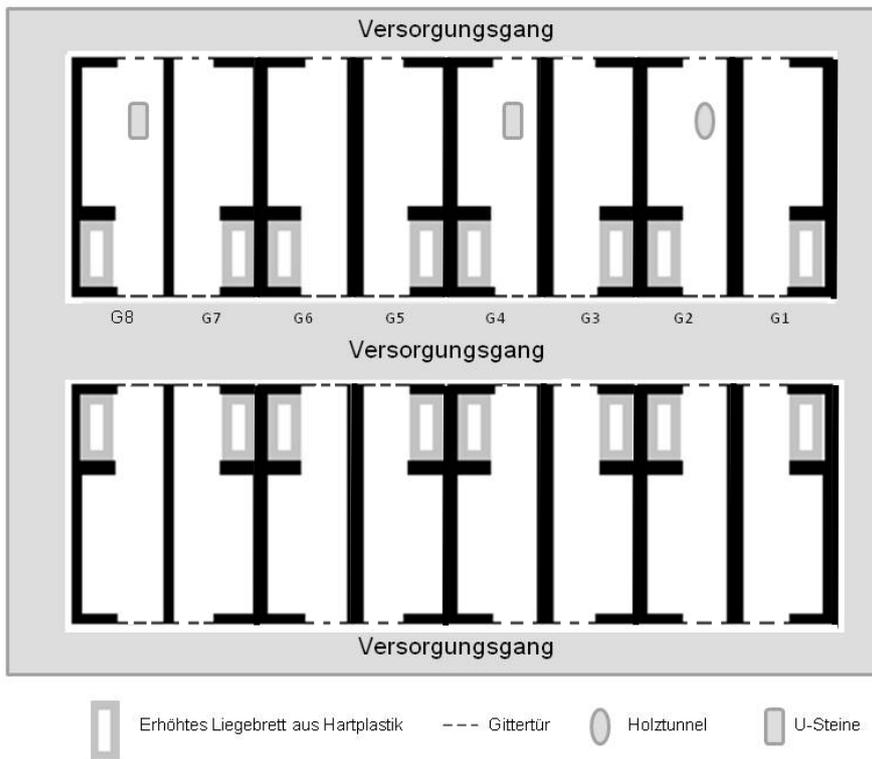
Grundriss (Ausschnitt) des Innenbereichs der Einrichtung B unter der Berücksichtigung von feststehendem Enrichment und sichtdurchlässigem Material (Gittertür)
